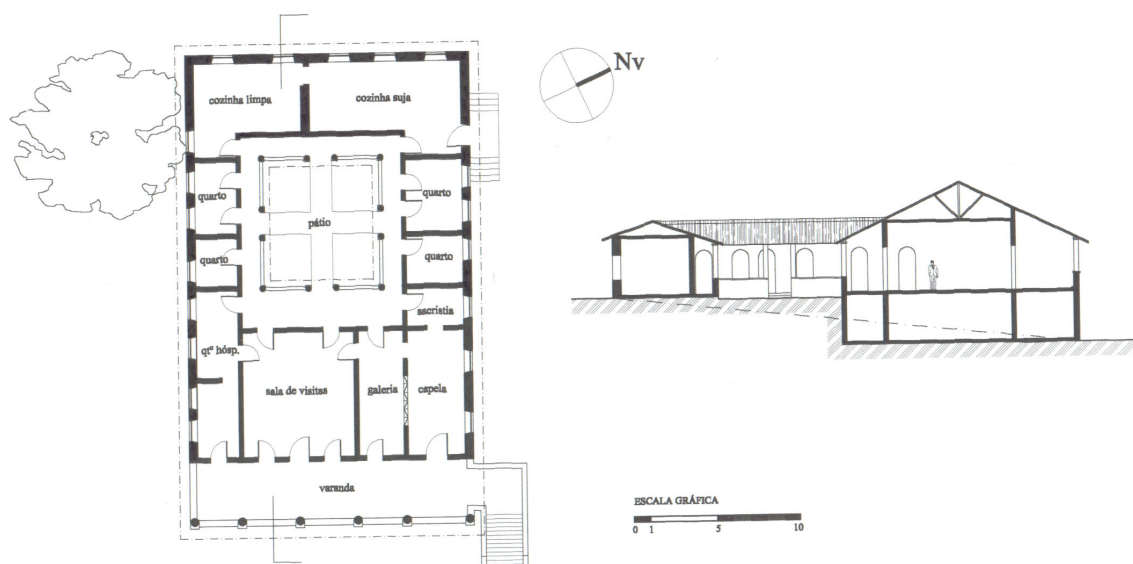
Planta Baixa de Arquitetura e Corte Longitudinal.
